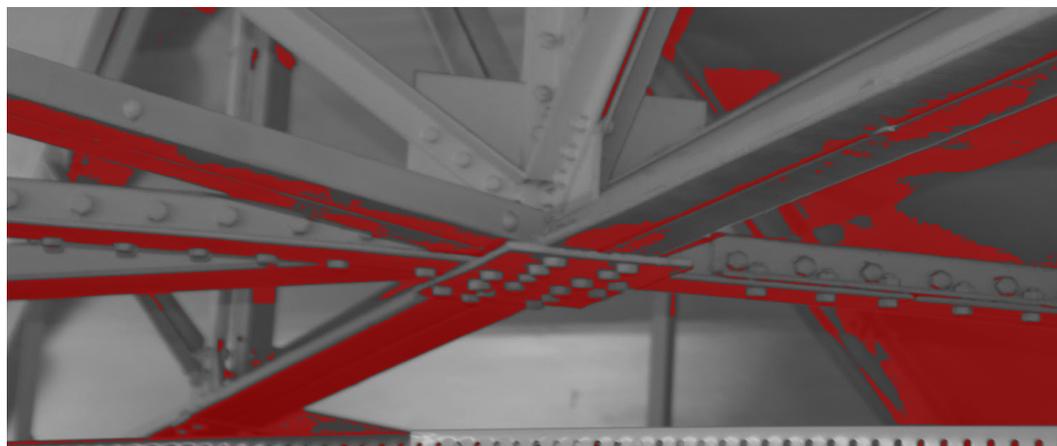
| Detalle nudo de la cercha metálica que conforma la estructura de cubierta del Edificio de Tabacalera.
